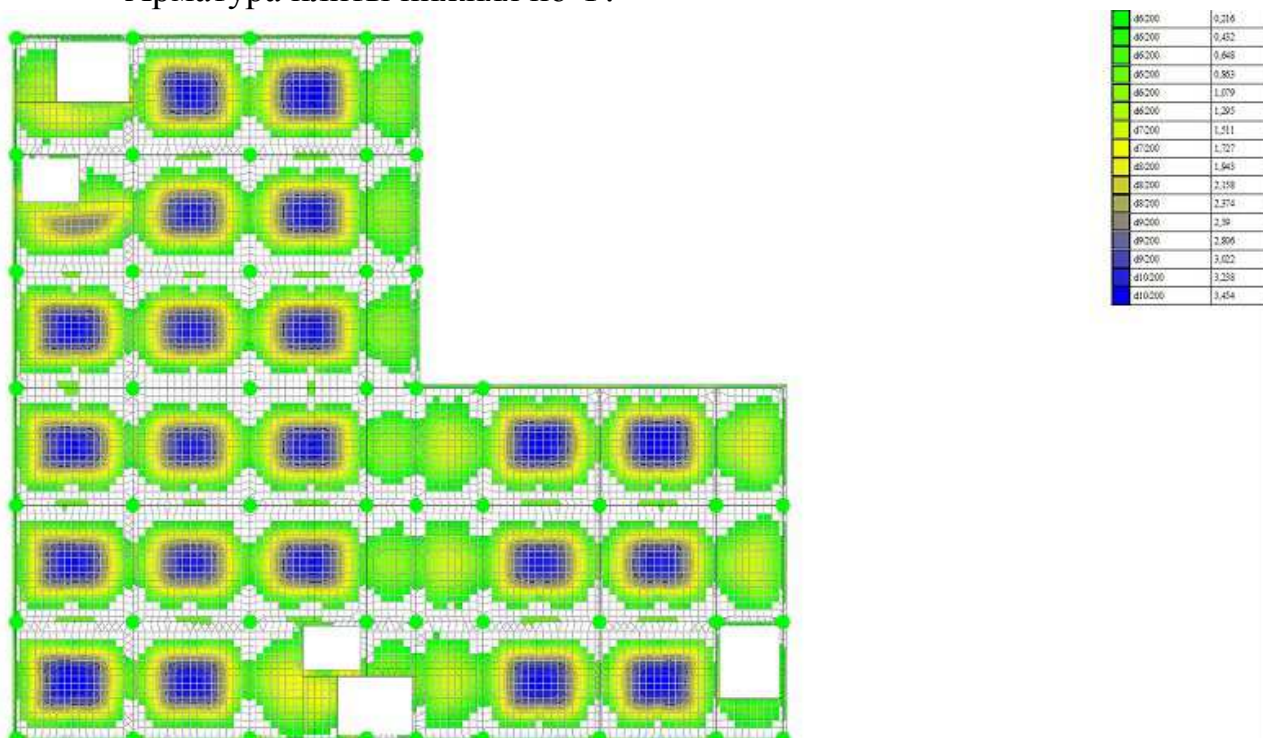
Схема нижнего армирования плиты по оси y
